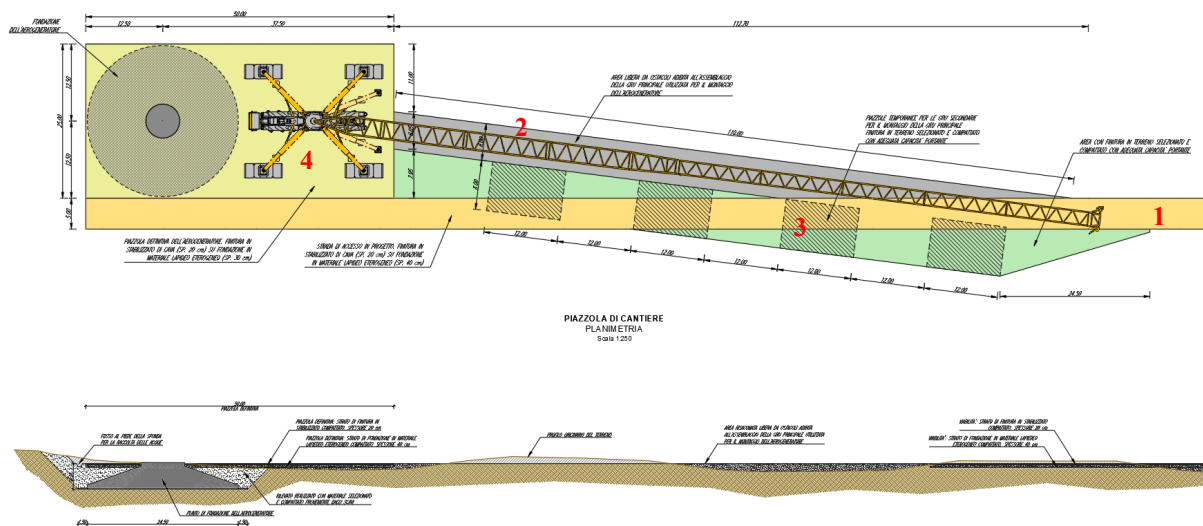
Piazzola di montaggio; 1. Strada di accesso; 2. Area di assemblaggio gru principale; 3. Area di lavoro gru ausiliare; 4. Area di lavoro gru principale.
